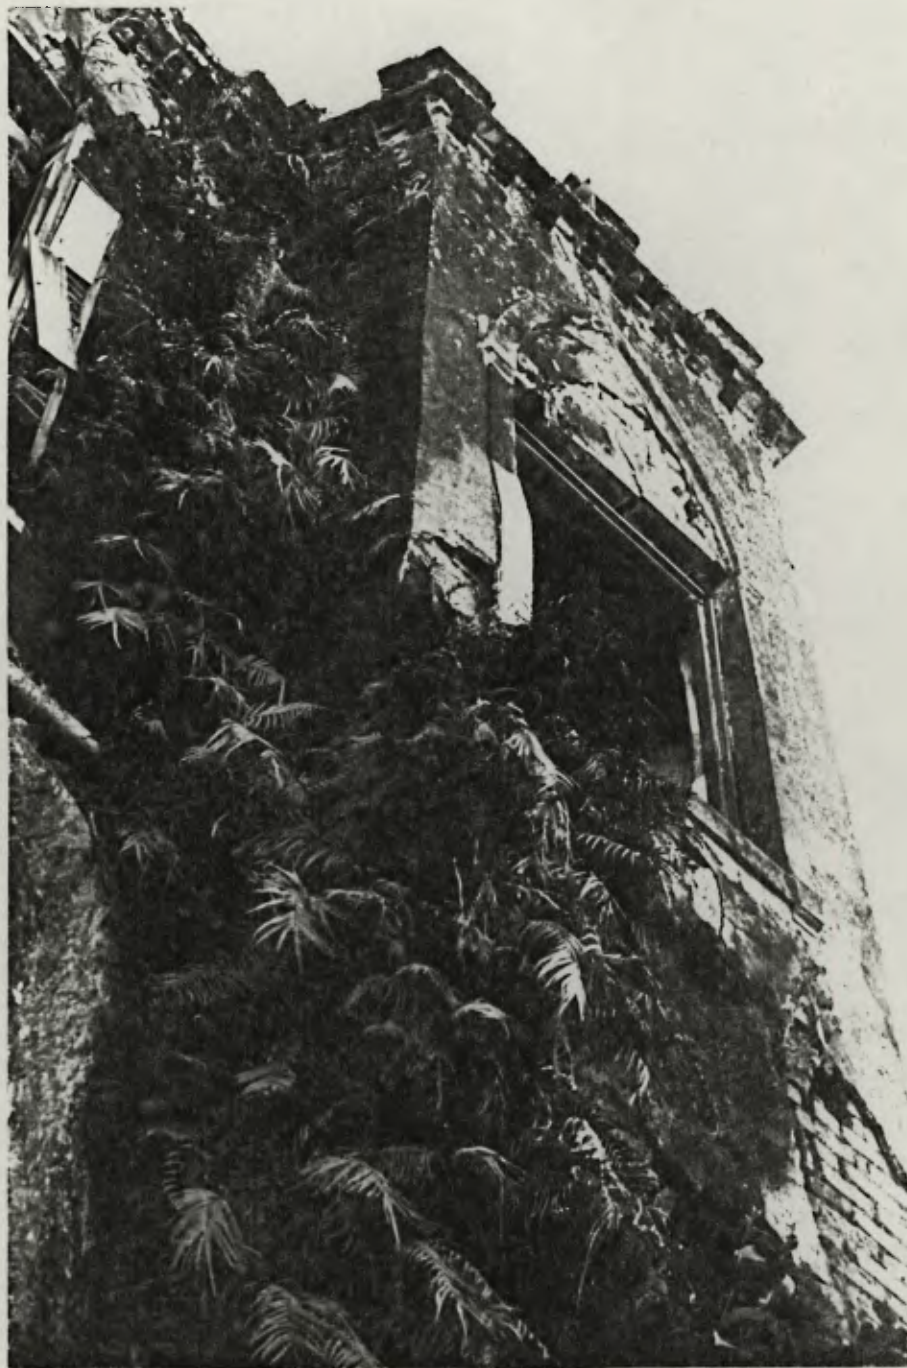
Detalhe do torreão direito da fachada sul. A janela que se vê é do banheiro.
